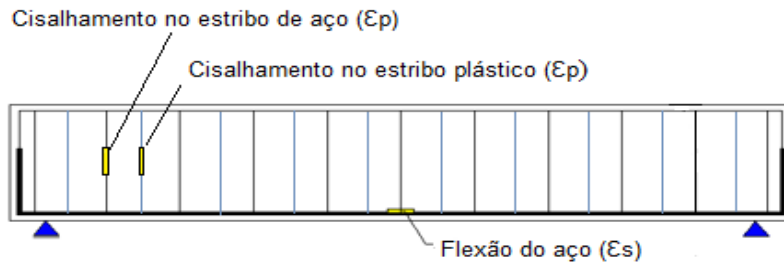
Posição dos extensômetros, sendo um no estribo plástico e outro no de aço.
